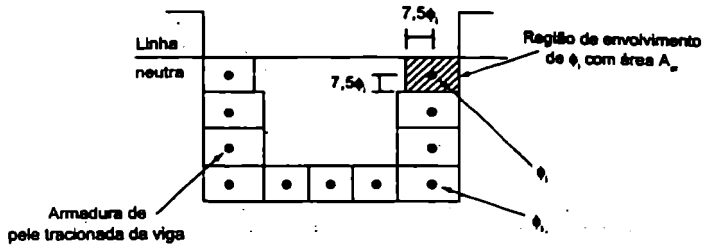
Concreto de envolvimento da armadura, conforme Figura 17.3 da ABNT NBR 6118:2014.
